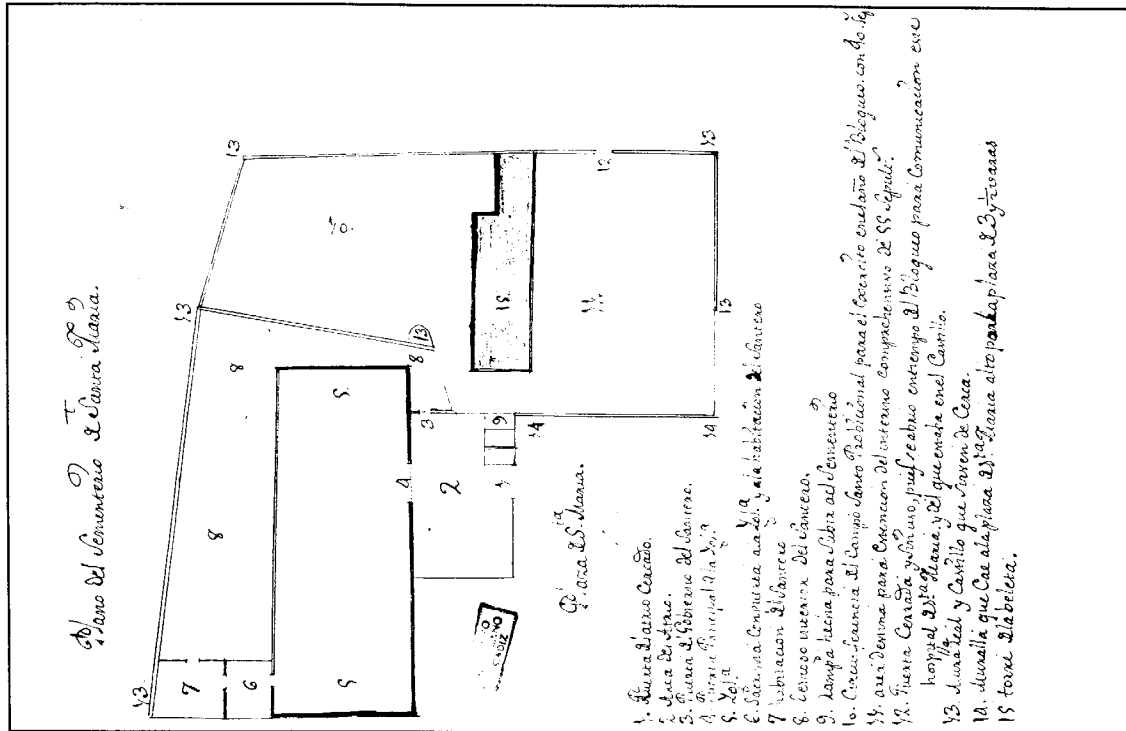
Plano del Cementerio de Santa Maria (Archivo Diocesano. Cádiz).
